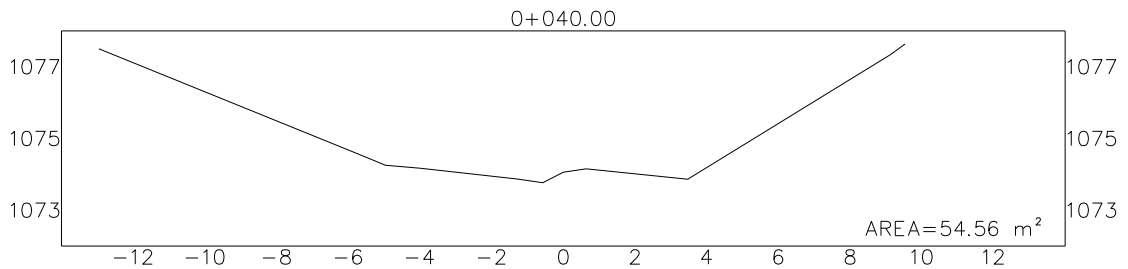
Sección transversal 0+040 de la zona del deslizamiento
